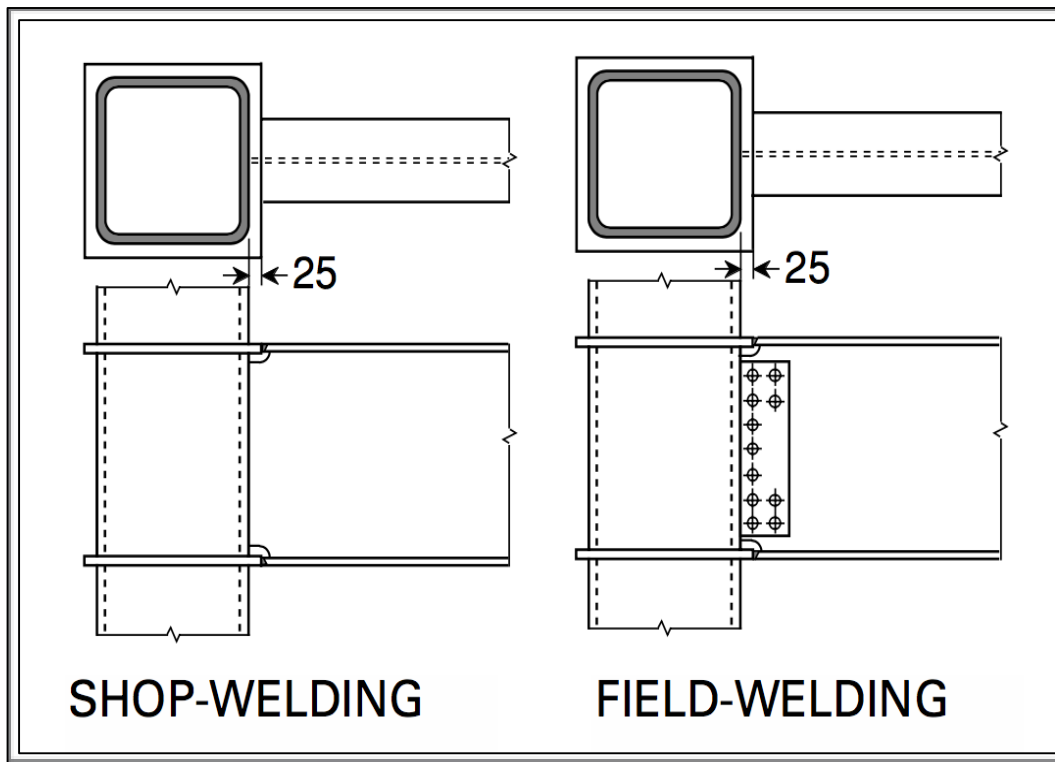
Conexión Soldada en taller y en sitio. (Packer, DESIGN GUIDE FOR STRUCTURAL HOLLOW SECTION COLUMN CONNECTIONS, 2004)
